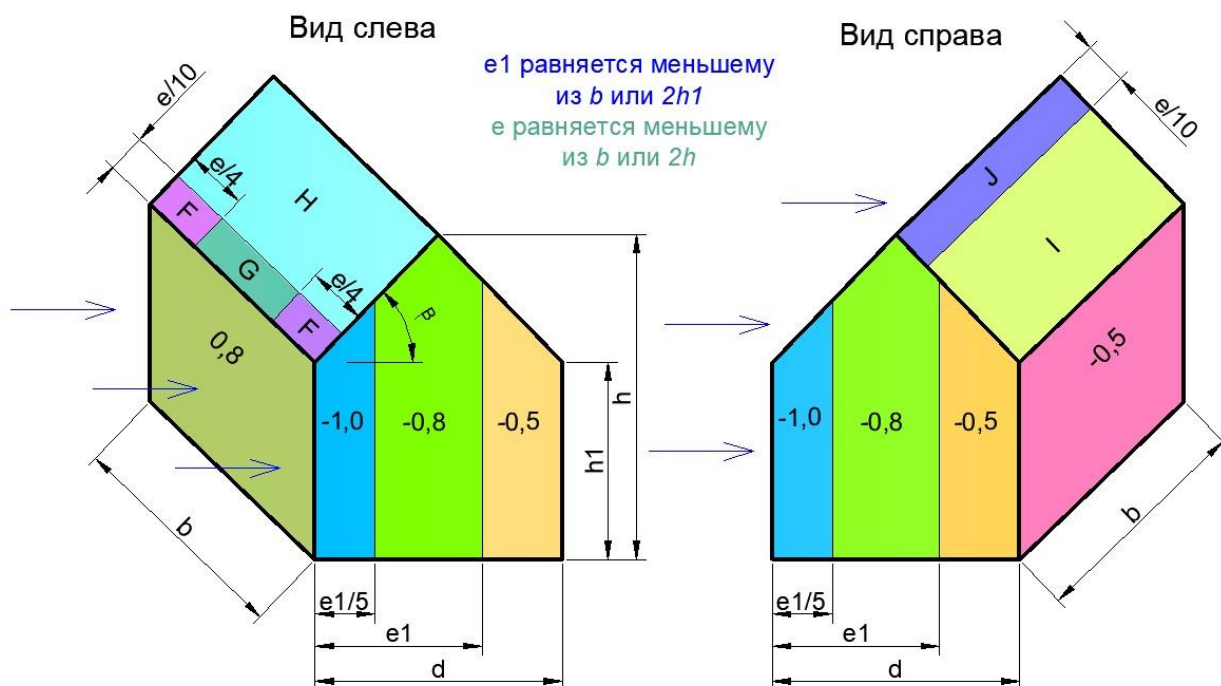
Схема ветровой нагрузки административно-бытового корпуса
